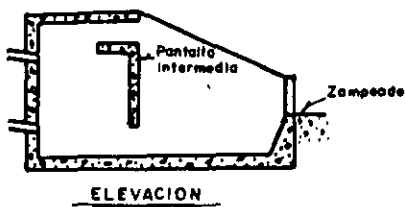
ESTRUCTURAS DE ENTRADA EN ALCANTARILLAS
